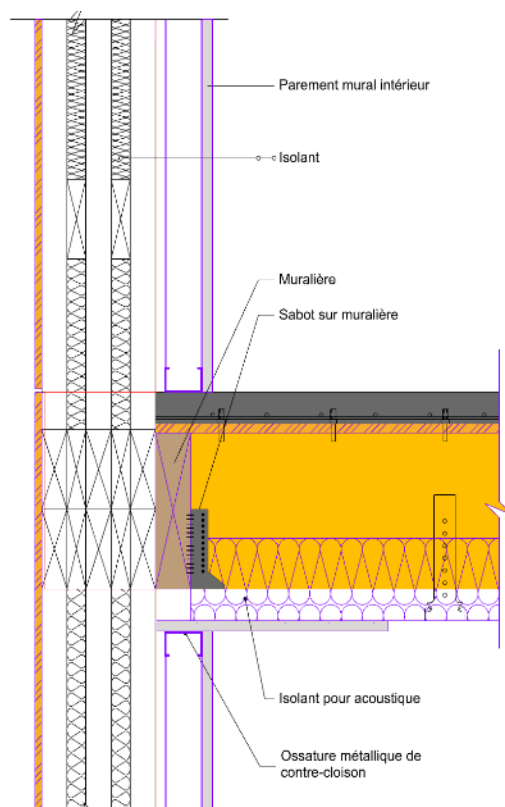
Exemple de Connexion entre mur LEKO LABS et plancher mixte bois béton (sous Avis Technique) avec muralière
